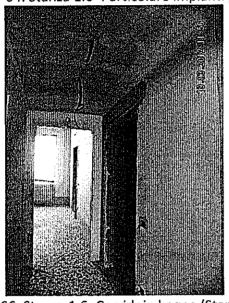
Stanza 1.6- Corridoio bagno (Stanza 1.7)
